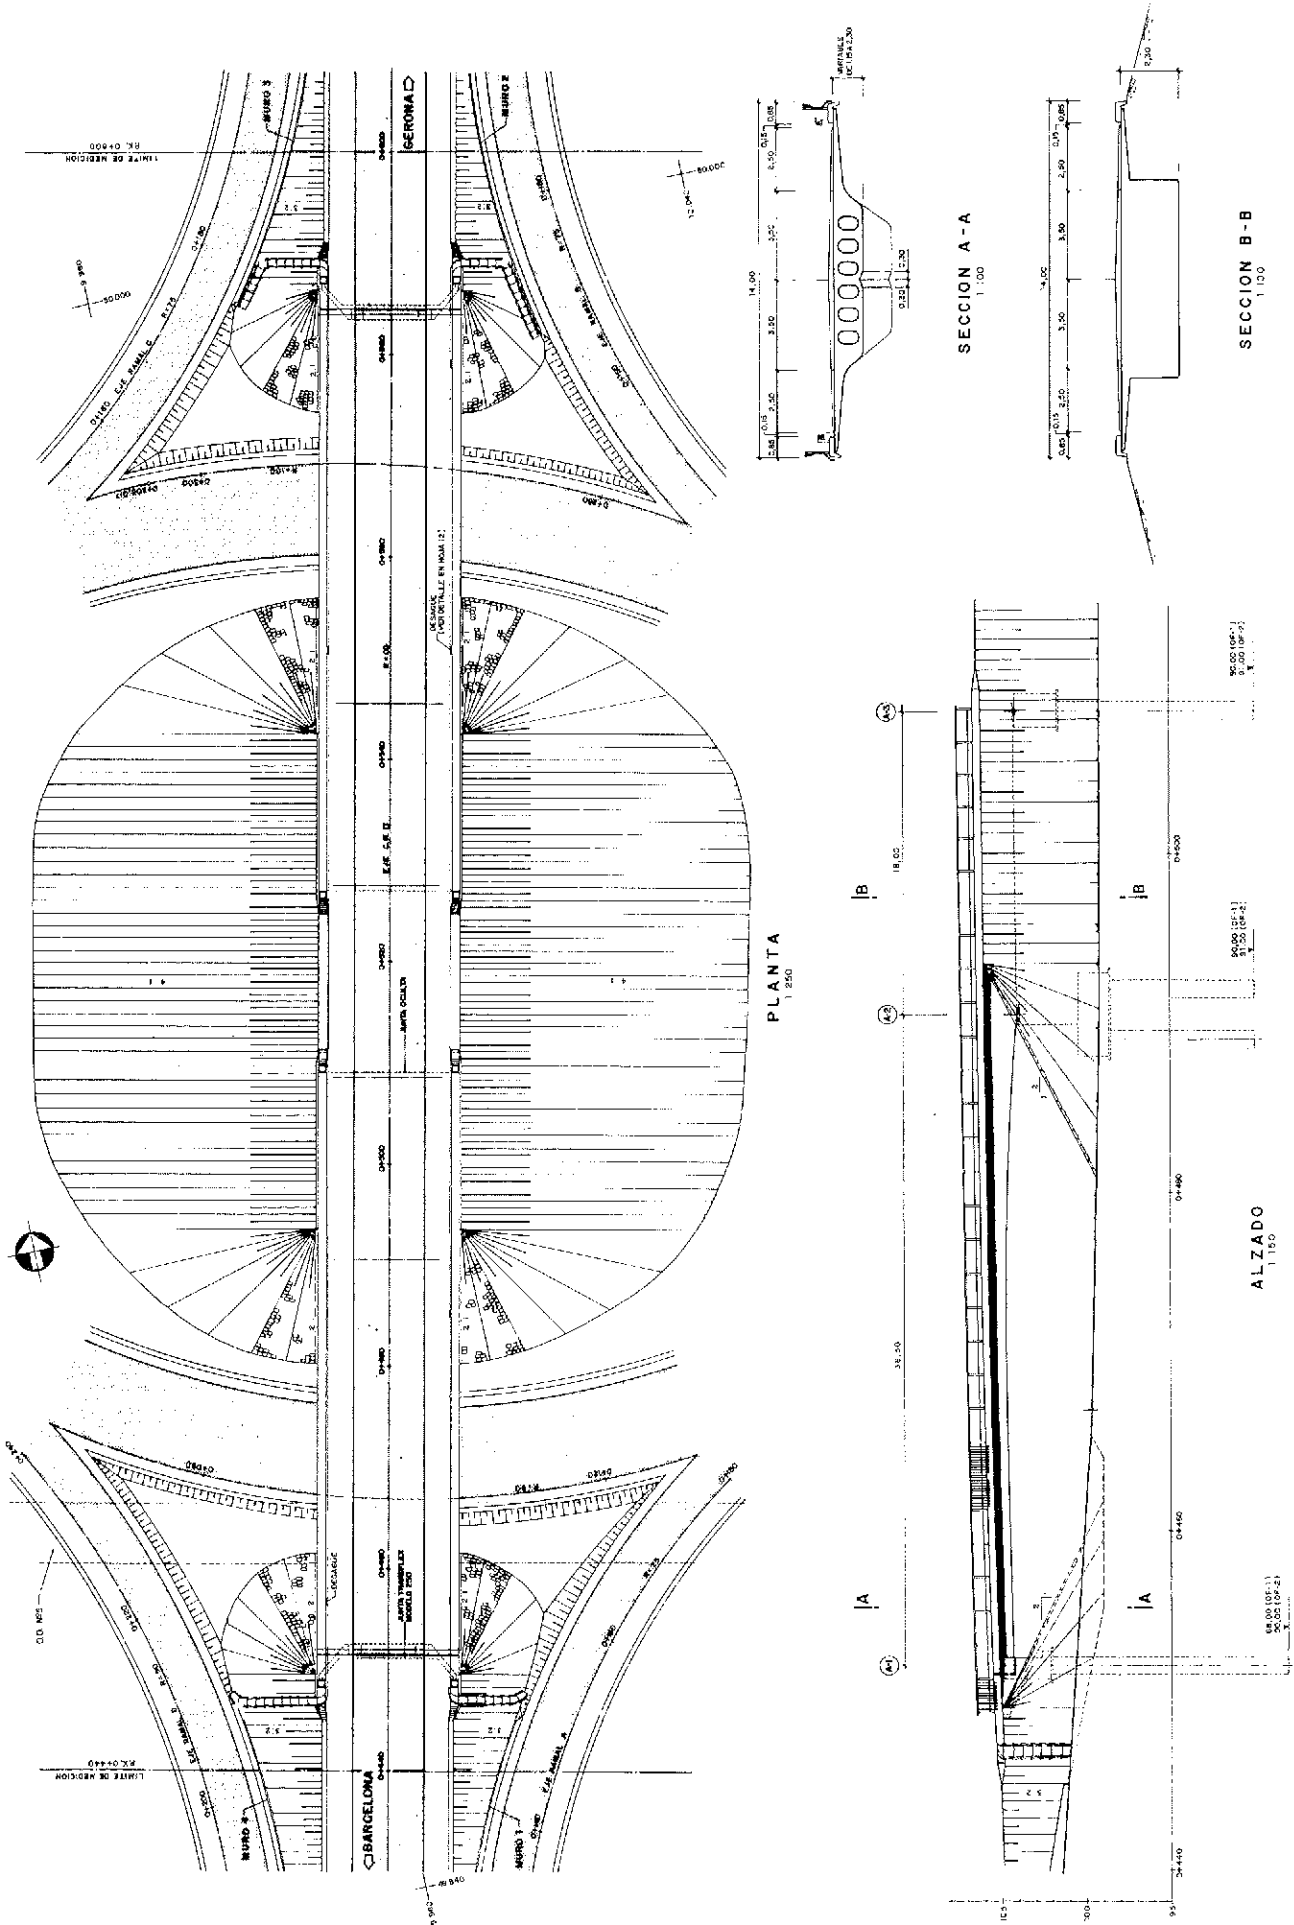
Planta y alzado de uno de los puentes con las secciones transversales características.
